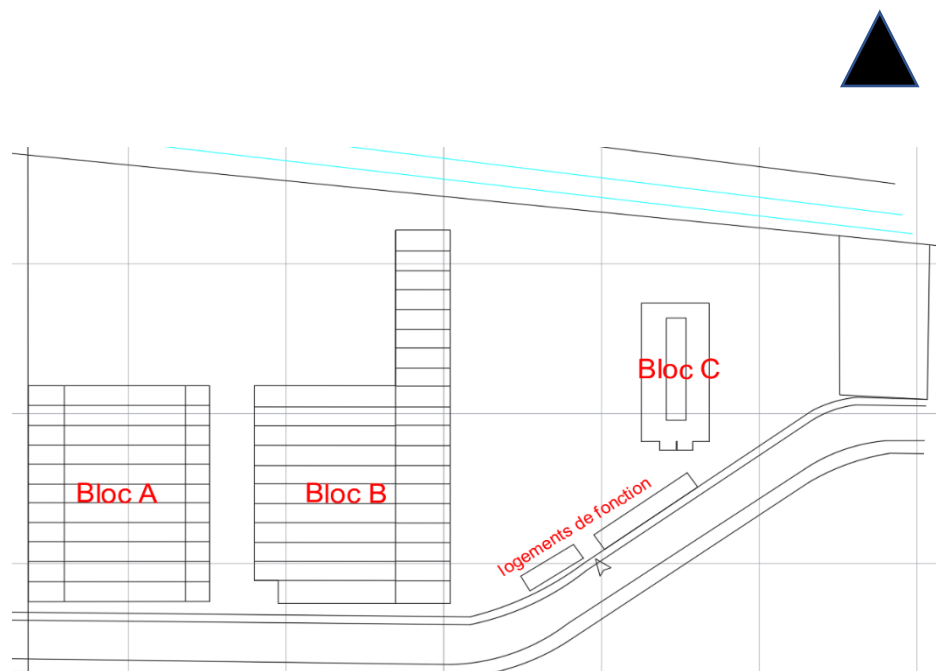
Schémas du bâti existant avant intervention. (Source :
